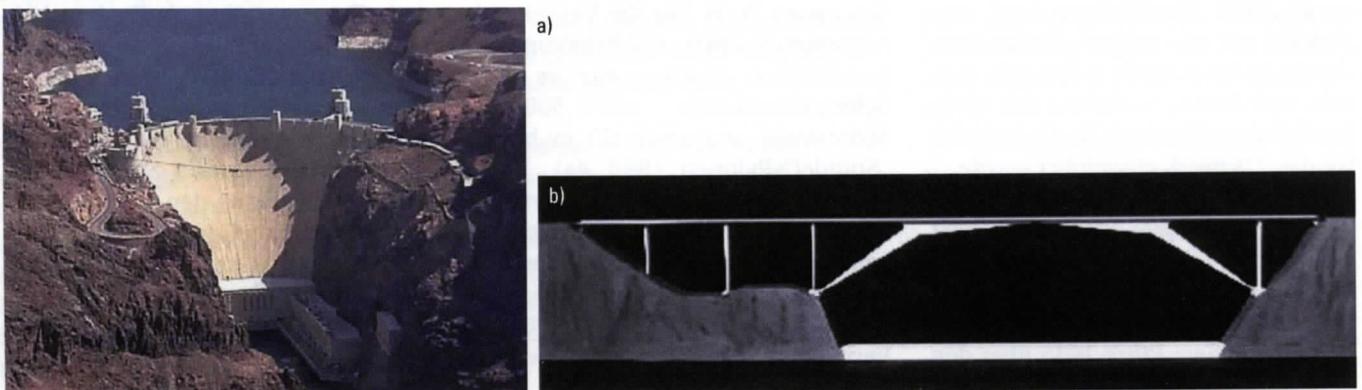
Hoover Dam Bridge mit a) Staumauer und b) Menn's Entwurf (2001)
